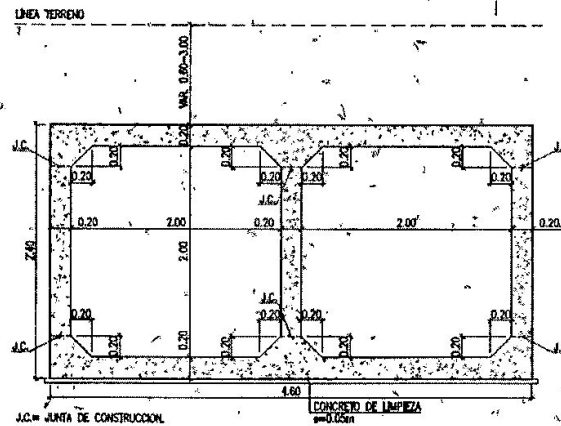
Sección transversal de la ALCANTARILLA TIPO CAJON DOBLE (2x2m – 0.6m < H <= 3m).
